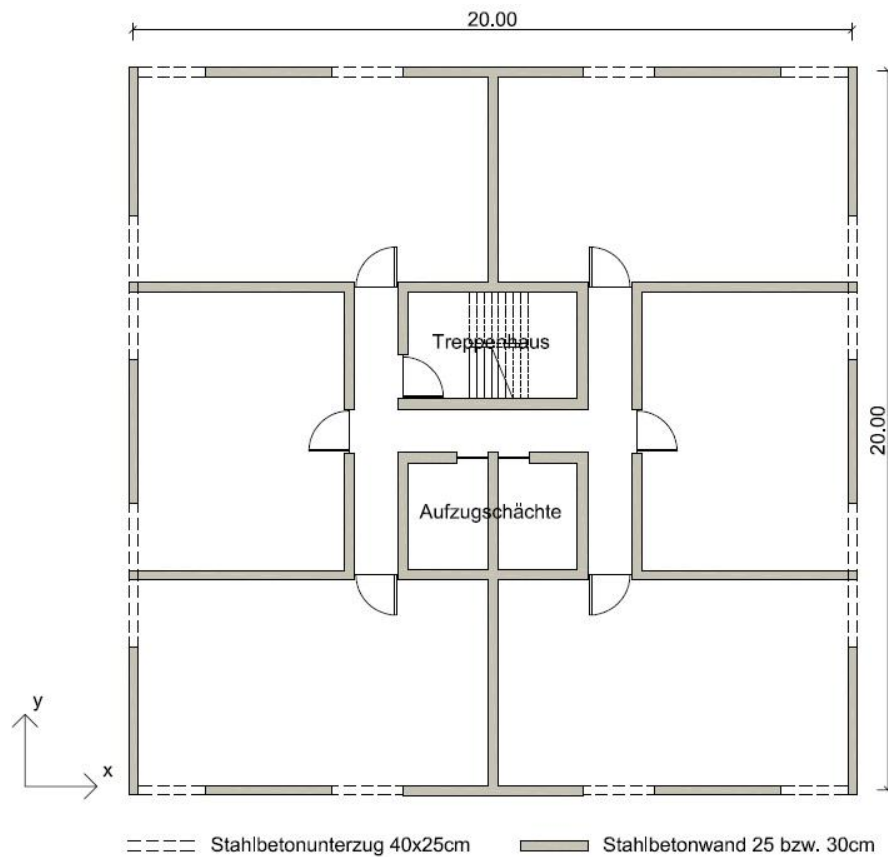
Grundriss der reinen Stahlbetonkonstruktion
